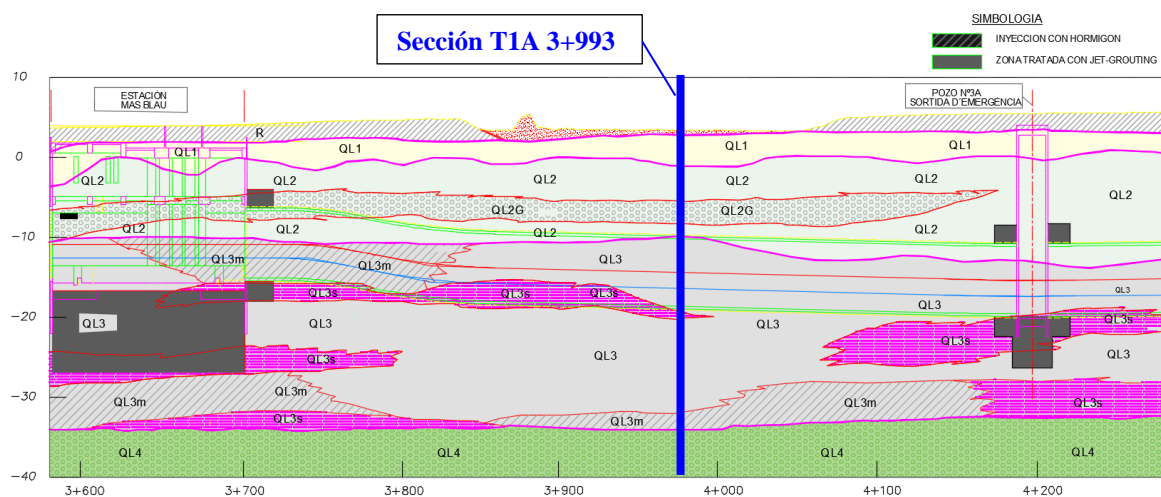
25. Perfil geológico y instrumentación colocada en el terreno de la sección de control T1A PK 3+993
